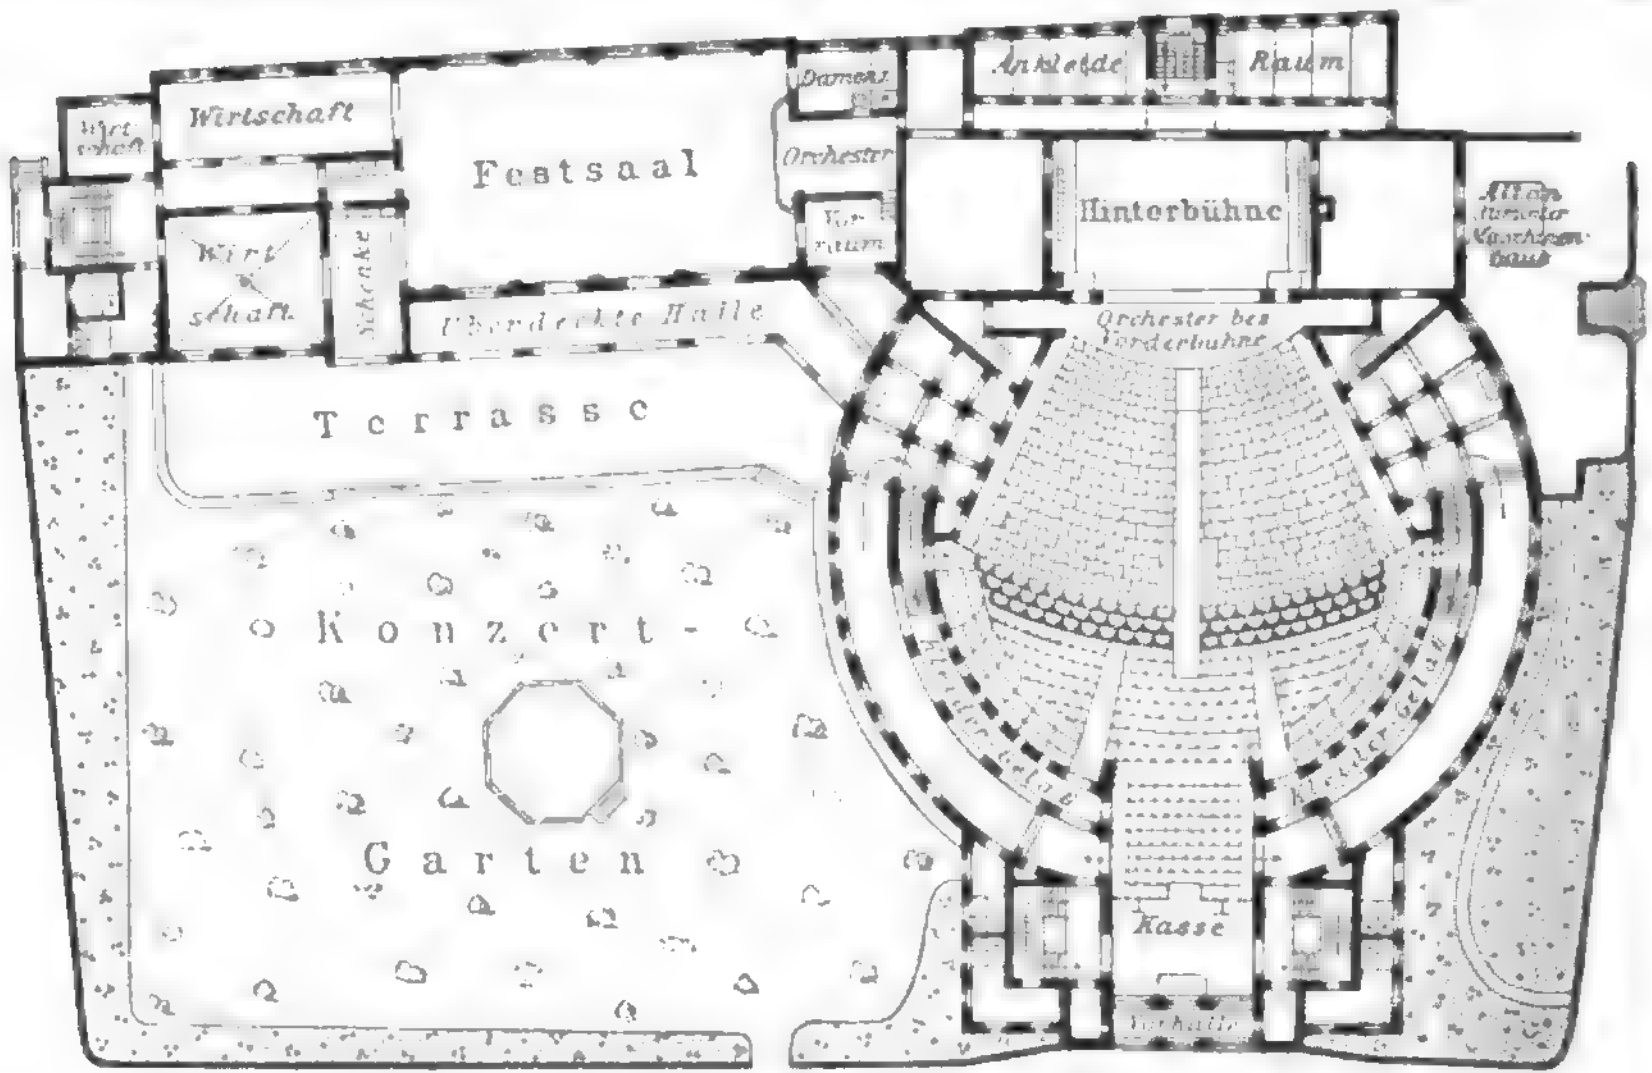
Grundriß des Festspielhauses in Worms (1888).
